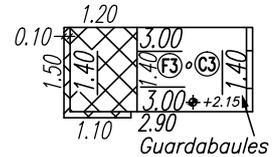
(d) DETALLA DEL PLACARD DEL GUARDABAULES
